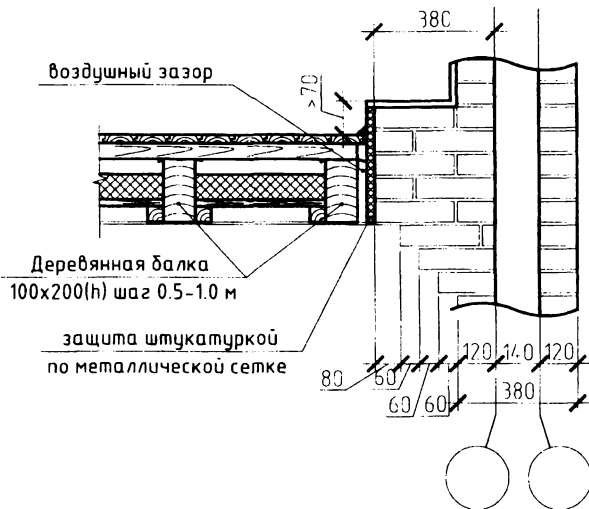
Узел примыкания балок перекрытия к дымовому каналу
